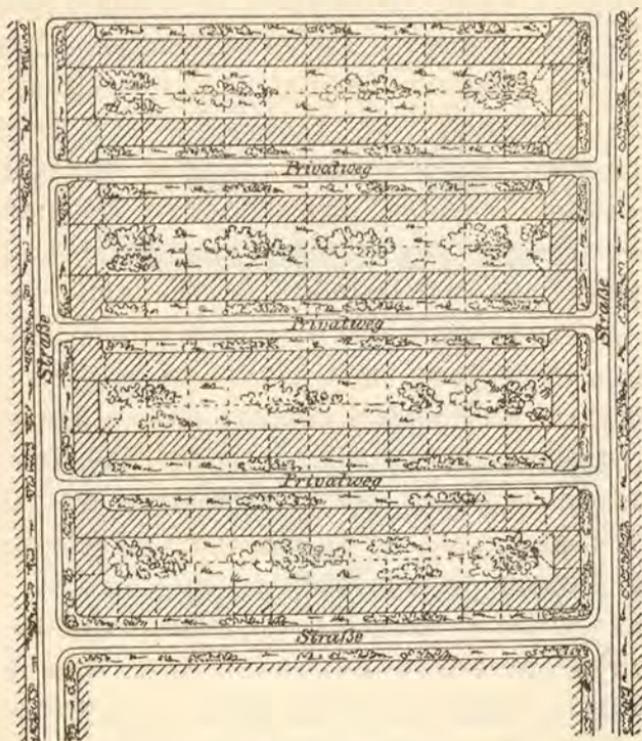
Жилые кварталы. Широкія улицы (Strasse) соединяются между собою узкими (Privatweg), обсаженными зеленью. Внутри дворовъ нѣтъ заднихъ флигелей; вмѣсто отдѣльныхъ дворовъ получаютъ общіе большіе сады.
